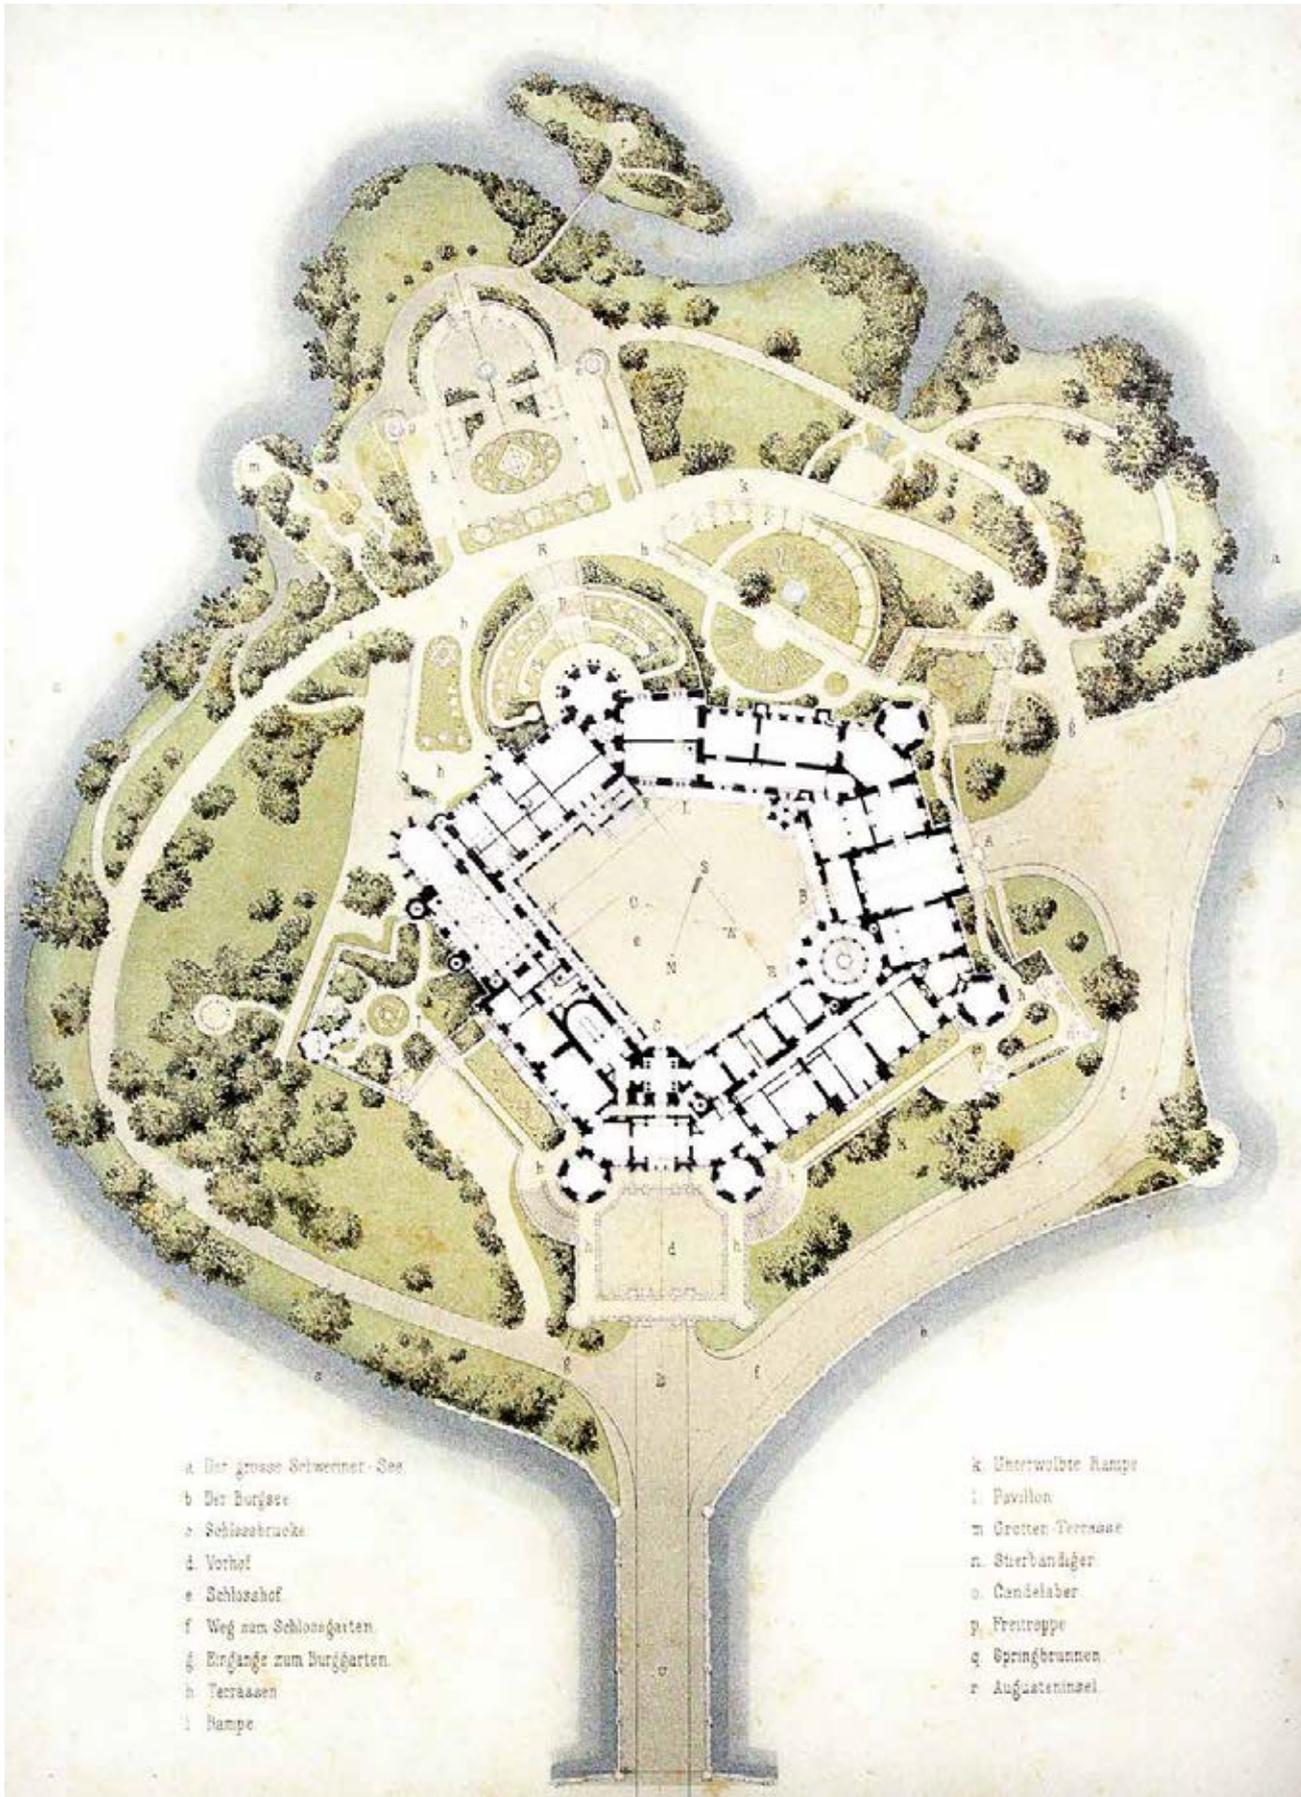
Das Schloss zu Schwerin Situationsplan und Grundriss des Hauptgeschosses mit dem umgebenden Burggarten, aus „Das Schloss zu Schwerin“, Festschrift 1869, LAKD MV/LD Fotosammlung
